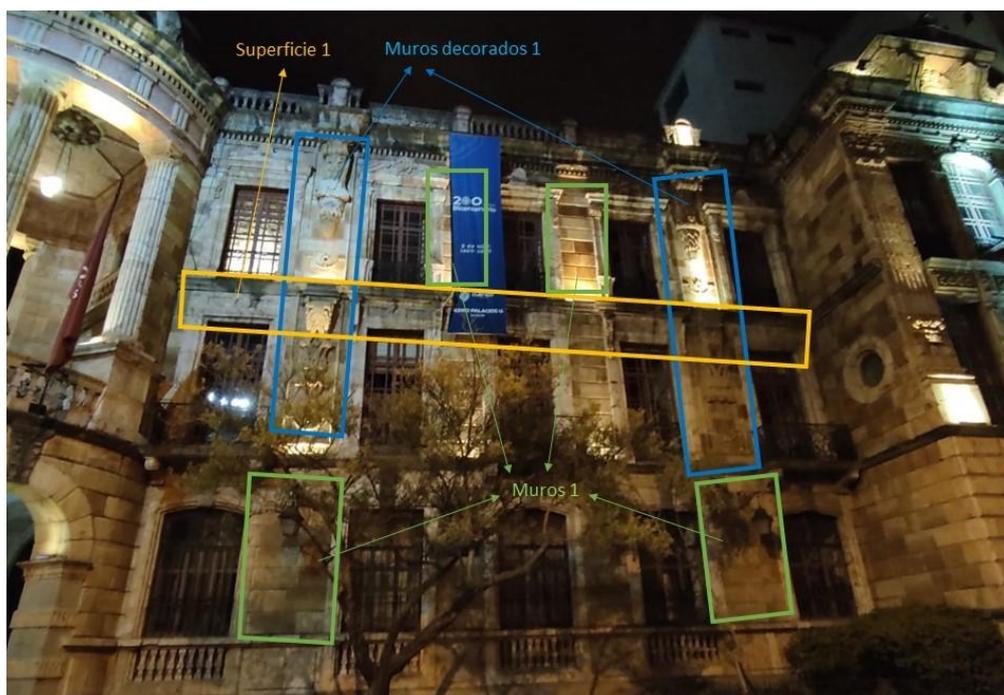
Secciones de la fachada lateral Bolívar 1 Alcaldía. [Autores]
